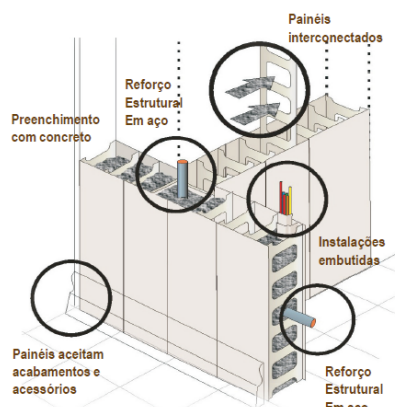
Sistema Pré-fabricado Concreto-PVC
